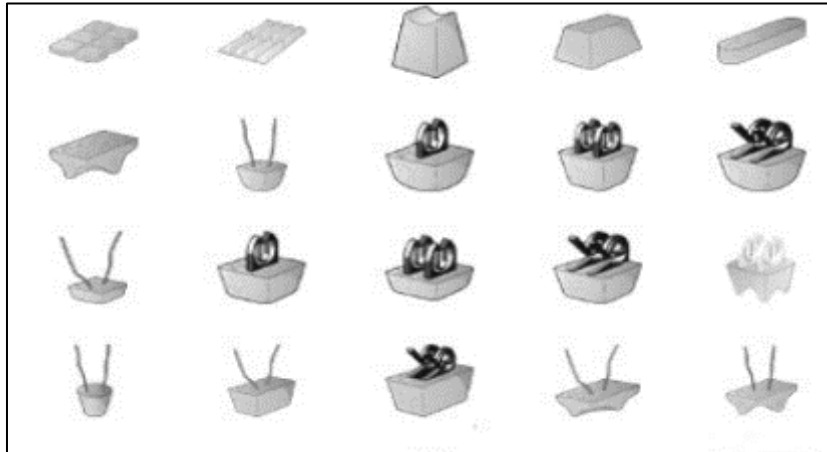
Figura 48. Diferentes tipos de separadores o distanciadores para concreto. Fuente: Separadores-hormigón-construcción-materiales-para-trabajo-obra.
